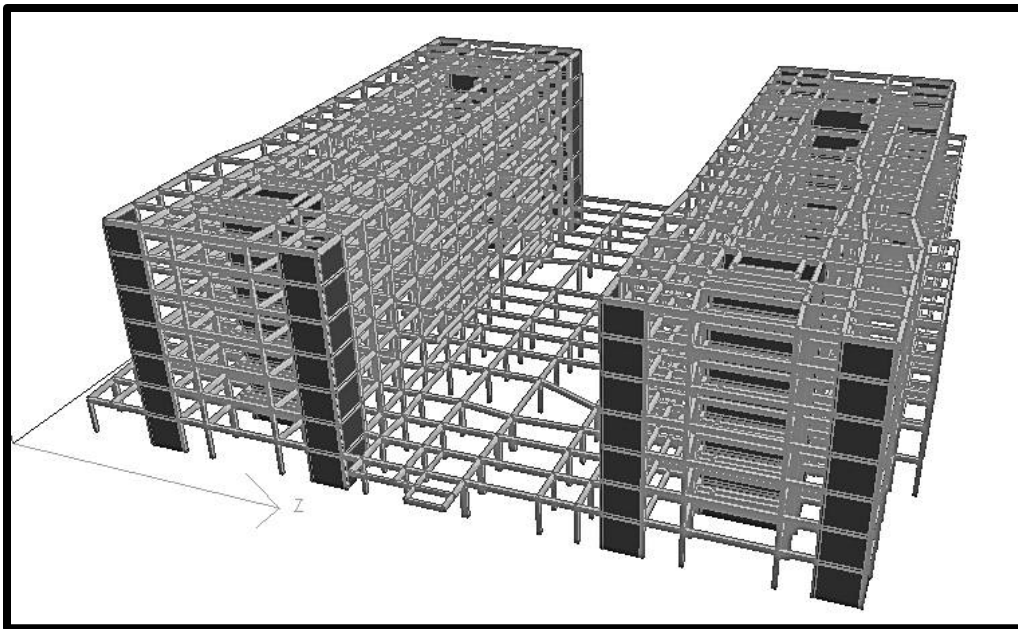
Modelo con muros de concreto a implementar. Fuente: Los autores
